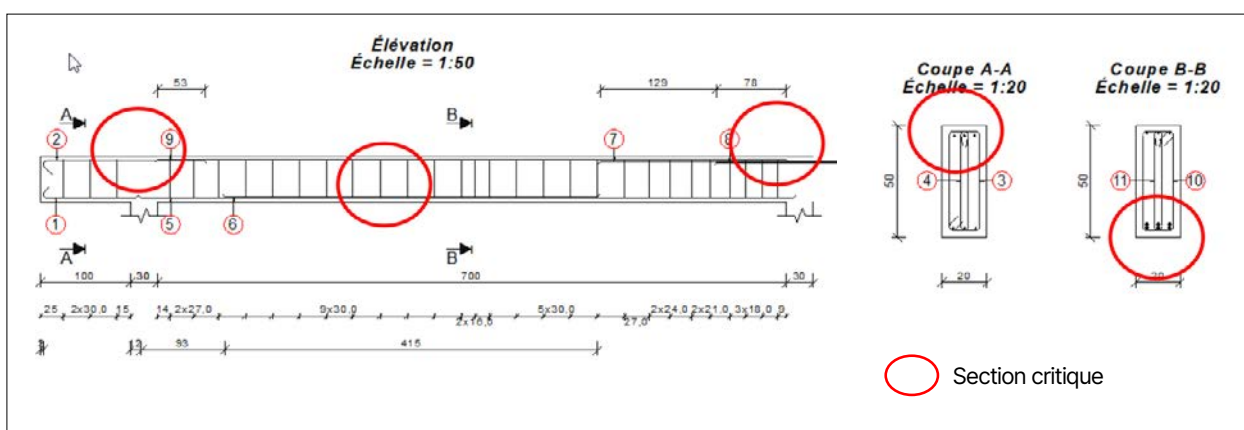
/4 : Exemple de plan de ferrailage comportant des zones critiques vis-à-vis de la corrosion des aciers longitudinaux
